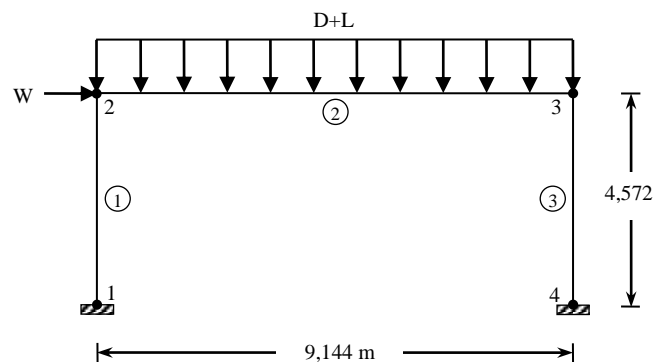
Pórtico plano com três elementos e ligações semirrígidas: geometria, carregamento e discretização
